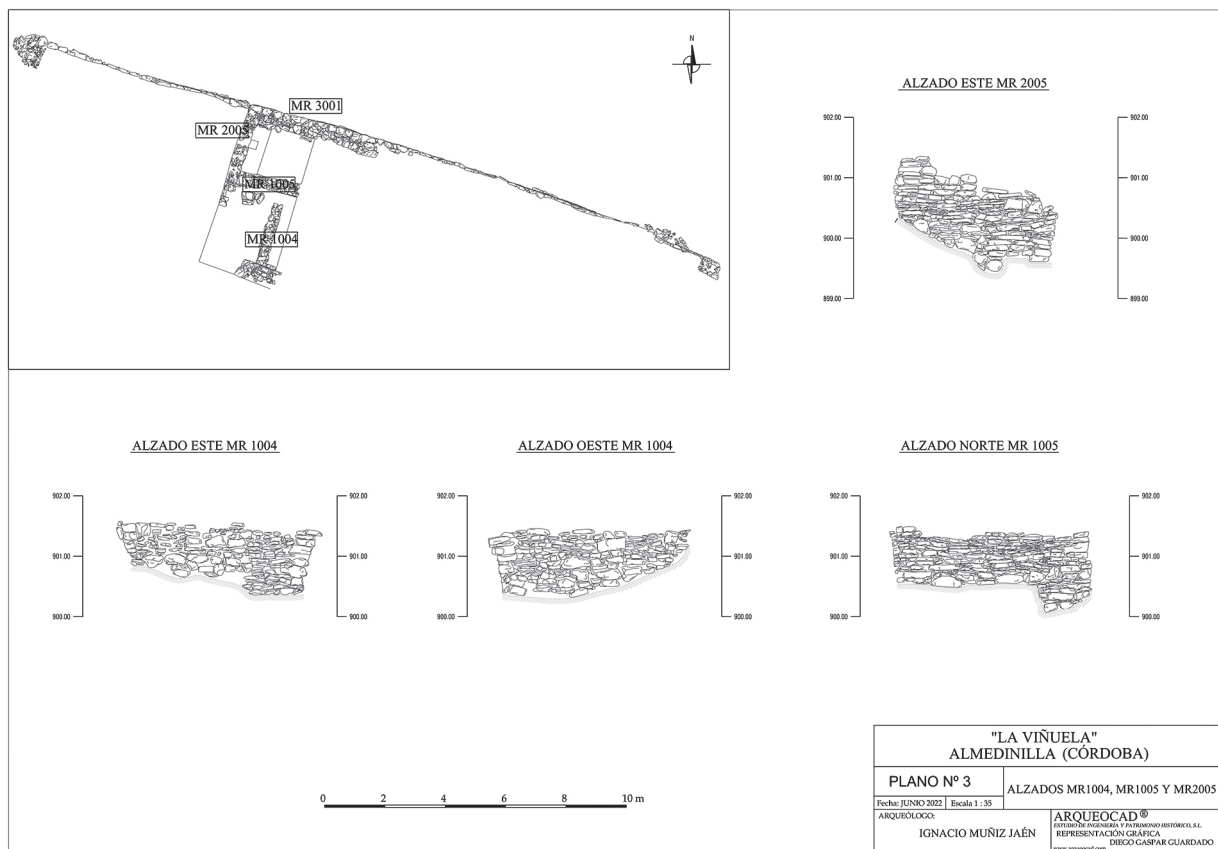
Planta de la zona exhumada y alzados de muros en La Viñuela.
